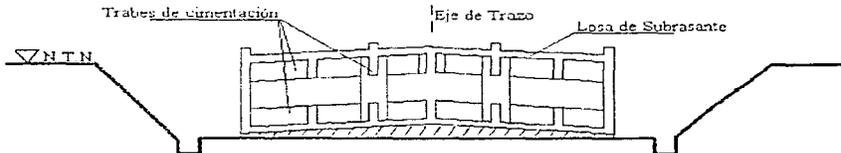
Armado y colado de la sección estructural y losa de subrasante
